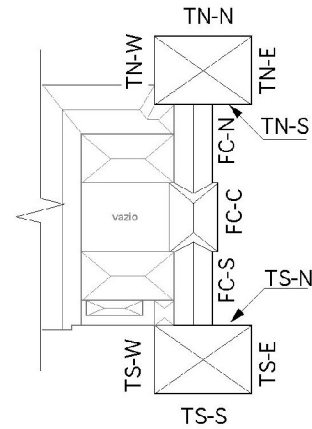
Croqui do Paço de São Cristóvão, indicando a sigla empregada para cada trecho de fachada
